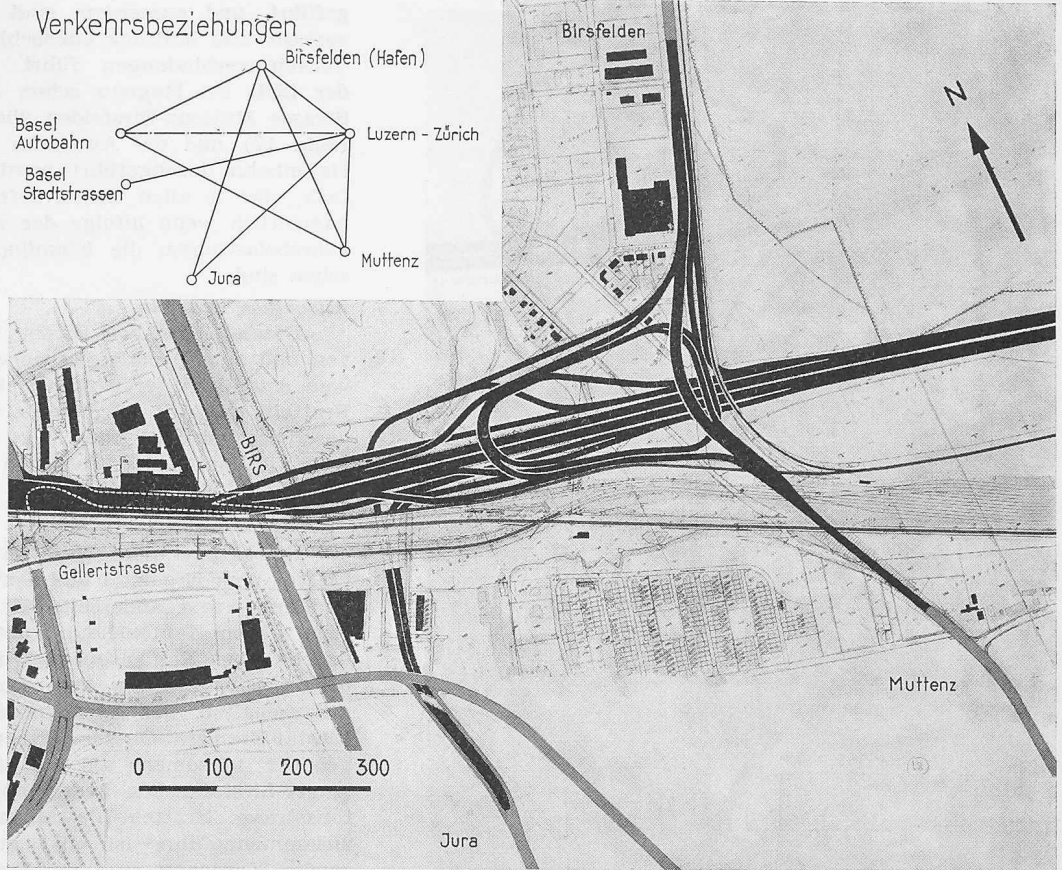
Anschluss Hagnau, Lageplan 1:10 000 mit schematischer Darstellung der Verkehrsbeziehungen
